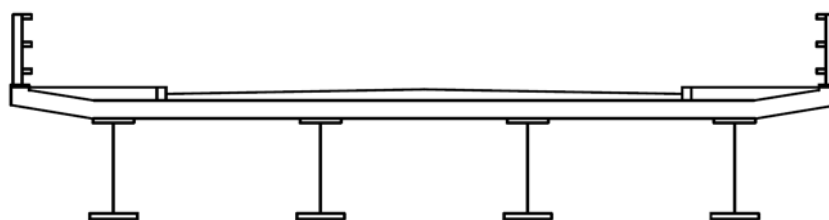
Secção transversal tipo da solução Multi-viga
